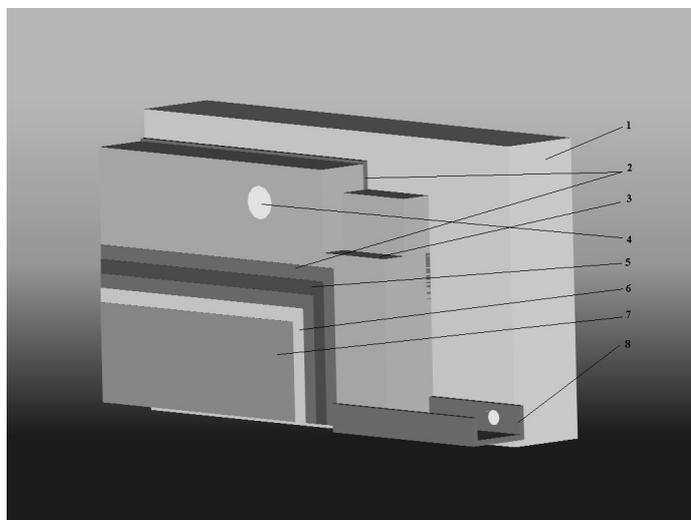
Система наружного утепления фасадов зданий "ФОРПЛАСТ":
